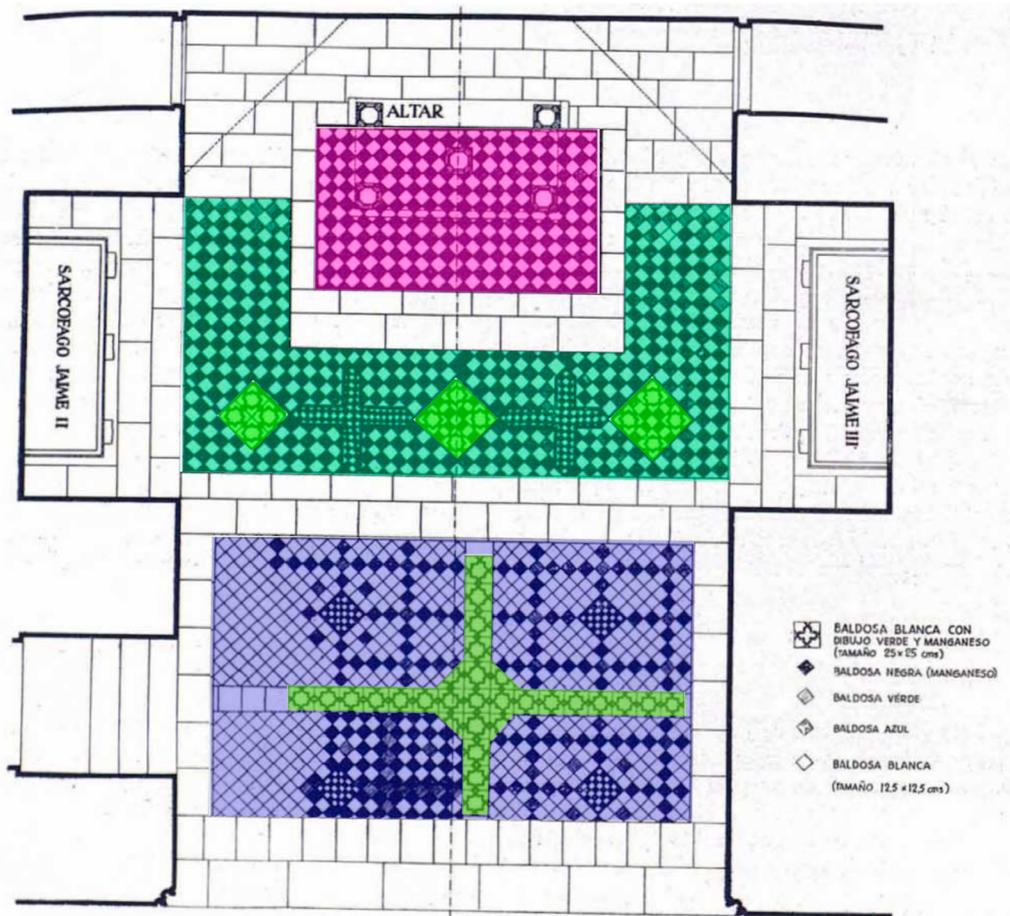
Planta de la Capella de la Trinitat y su pavimento.
